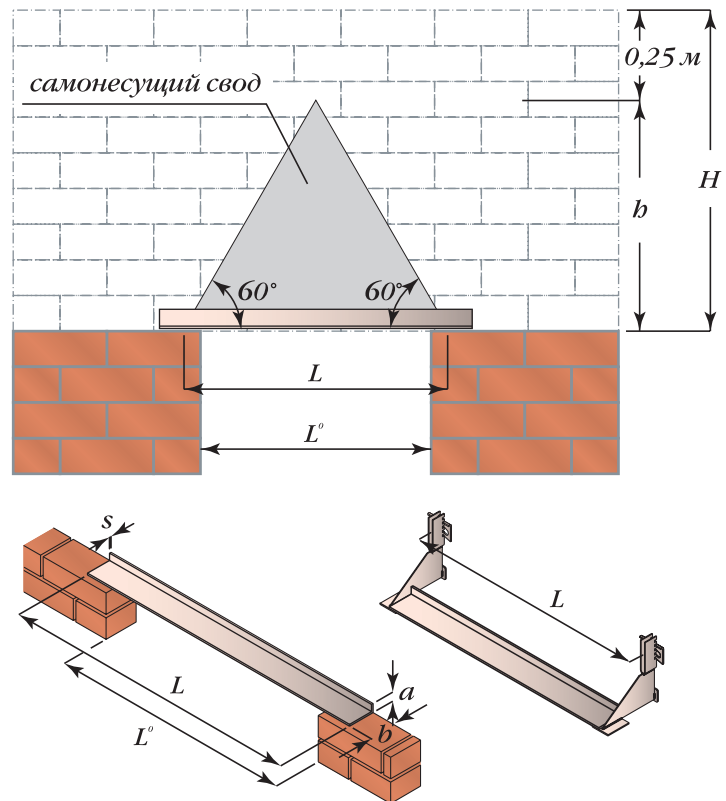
Перекрытие проёмов и вставка уголка между анкерами с использованием «самонесущего свода»
